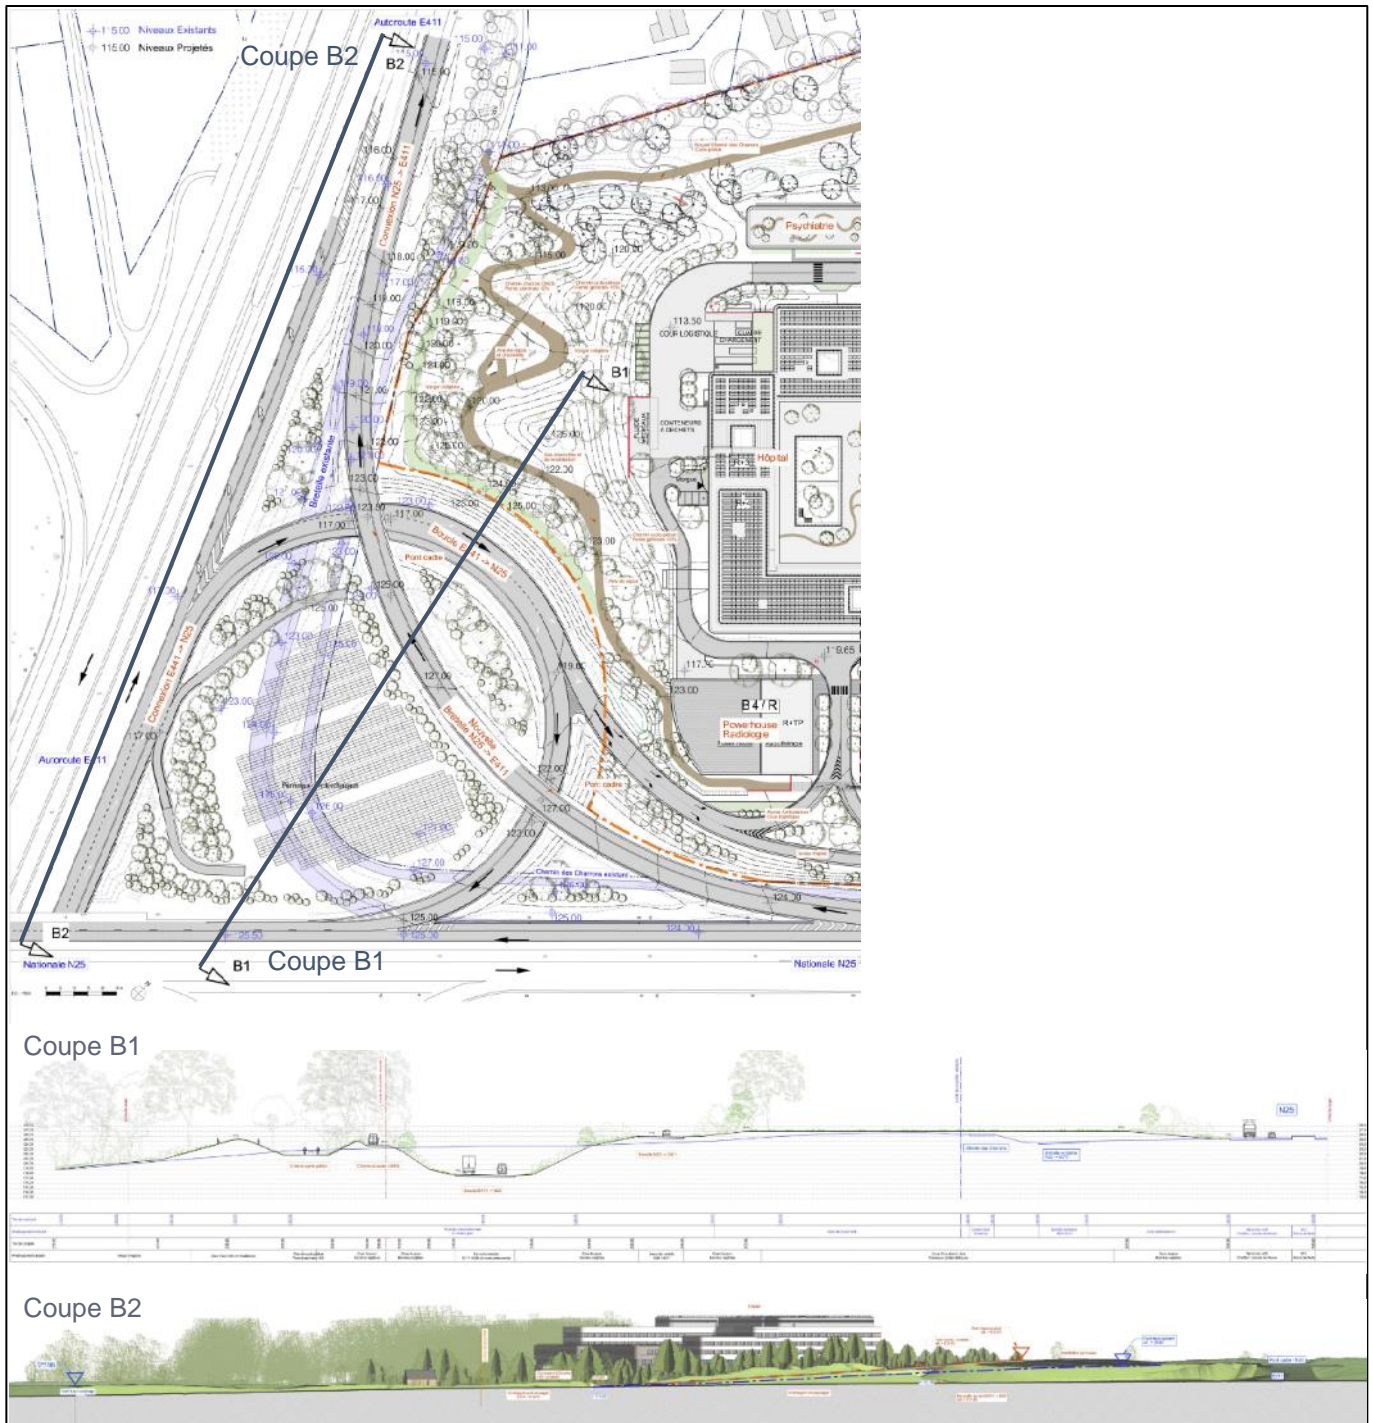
Coupes au niveau de la bretelle et plan de localisation des coupes (source : assar architects)
